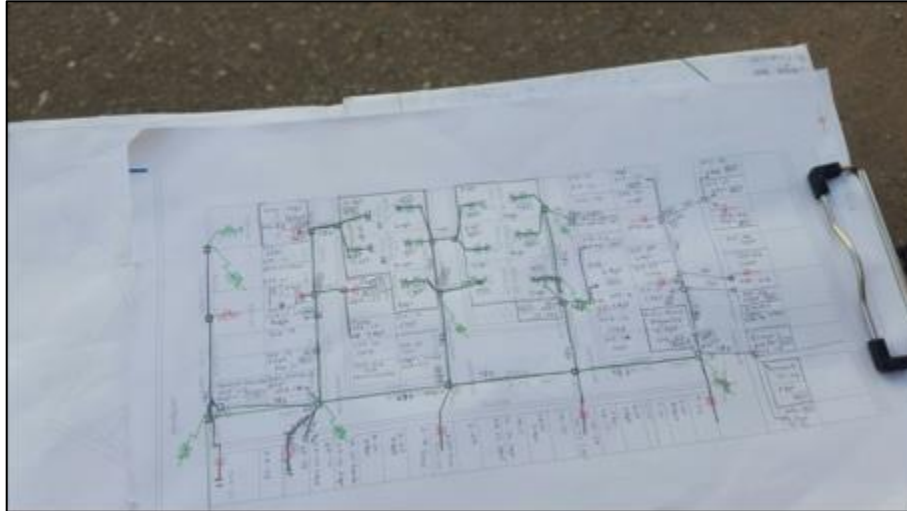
Levantamiento de canalización existente Centauros – Ciudadela Real de Minas
